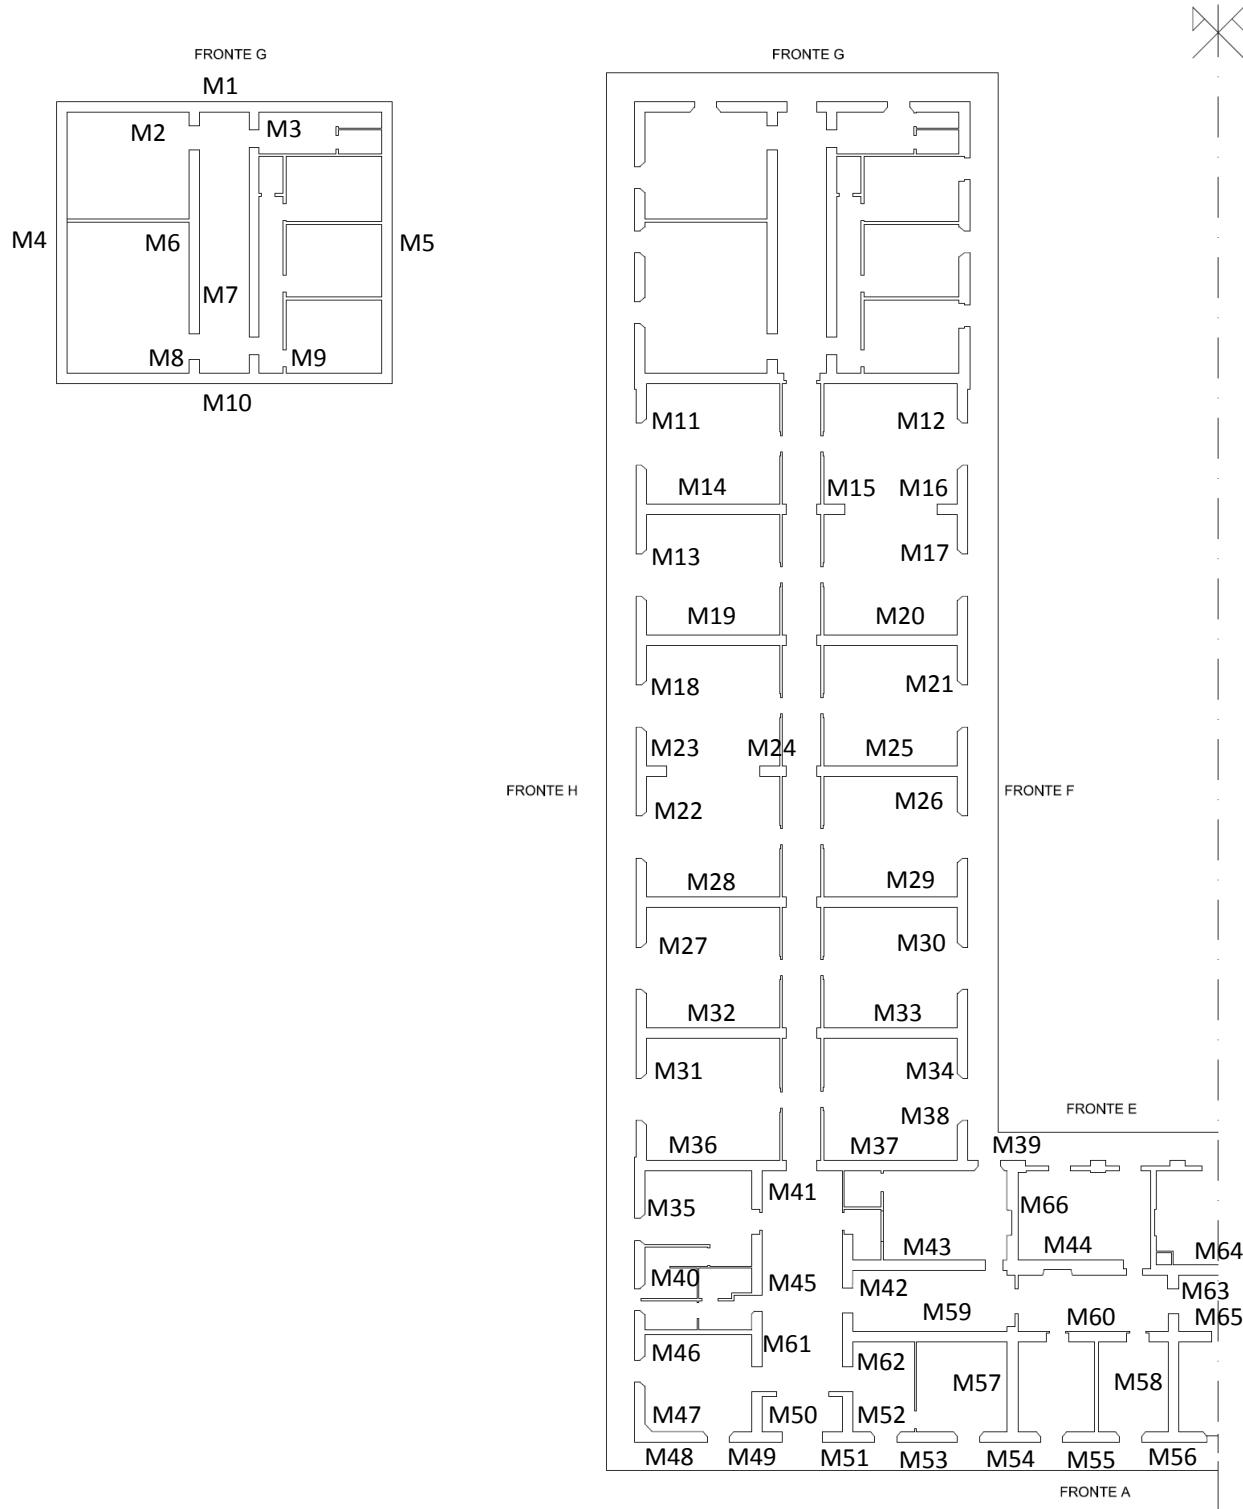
A sinistra pianta dei setti del piano interrato, a destra pianta dei setti del piano terra.
